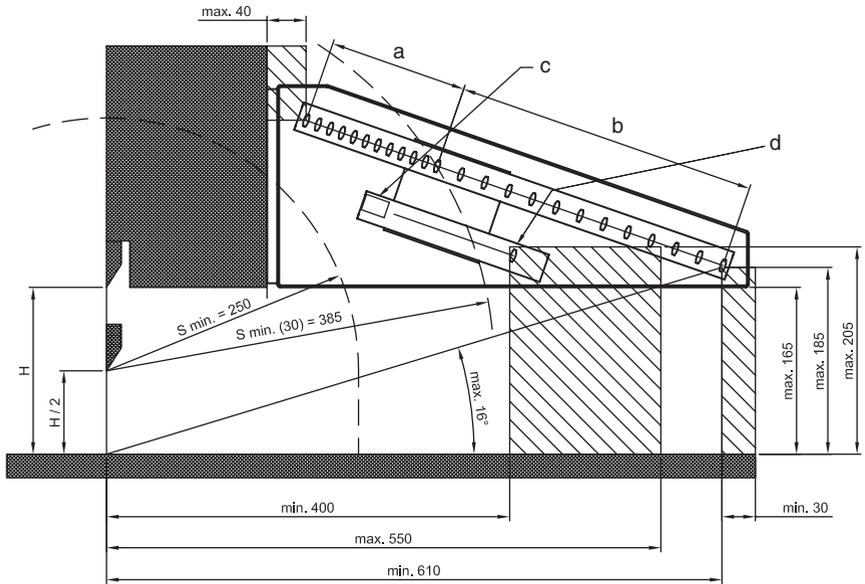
Montagevoraussetzungen bezüglich des Sicherheitsabstandes bei Öffnungen mit einer max. Höhe von 165 mm
